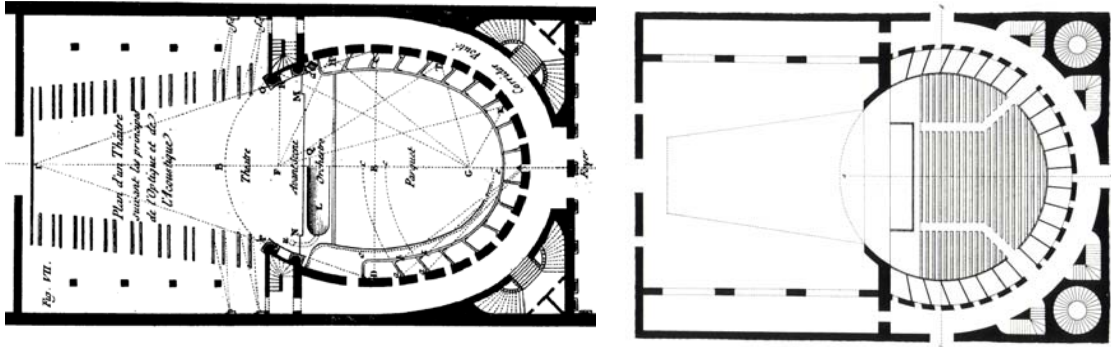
(Izq.) – Planta teatral diseñada por P. Patte (1782)
